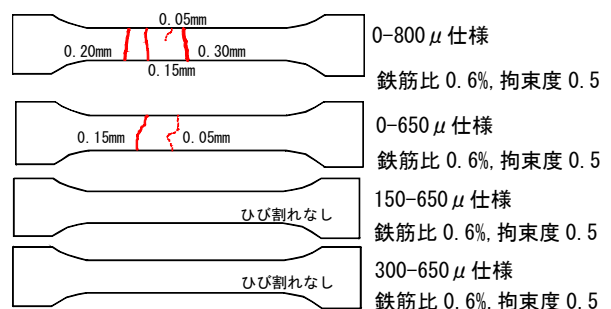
各試験のひび割れの発生状況(乾燥期間 52 週)
